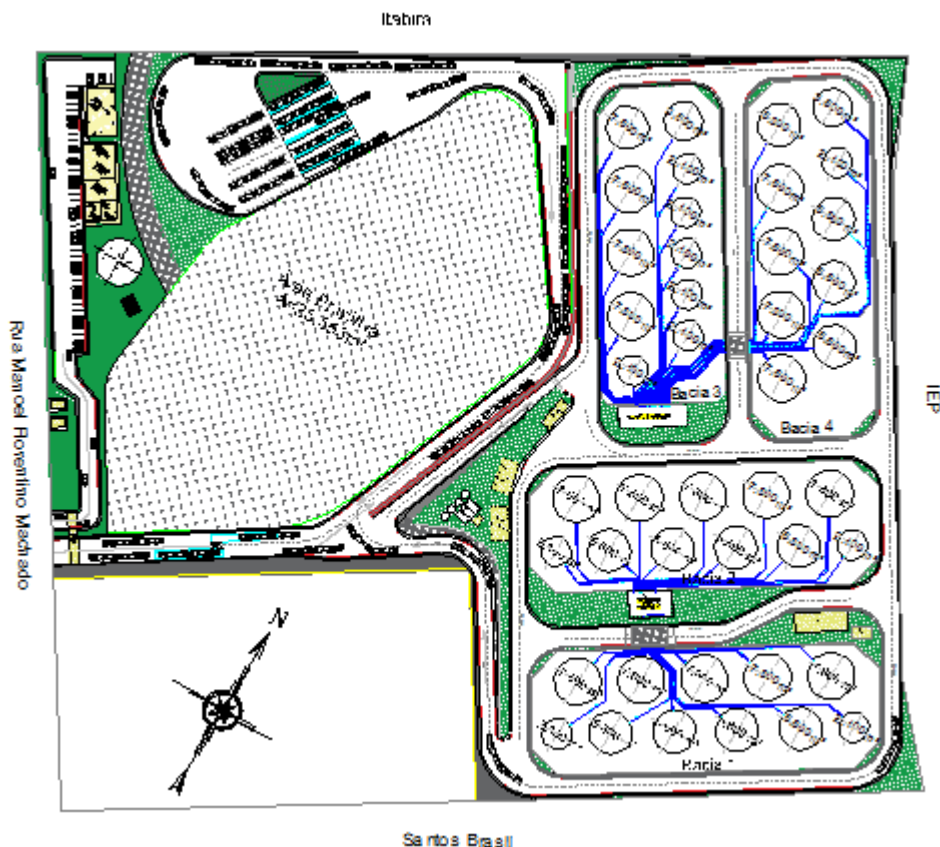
Planta da Fases 1 e 2 já implantadas.
